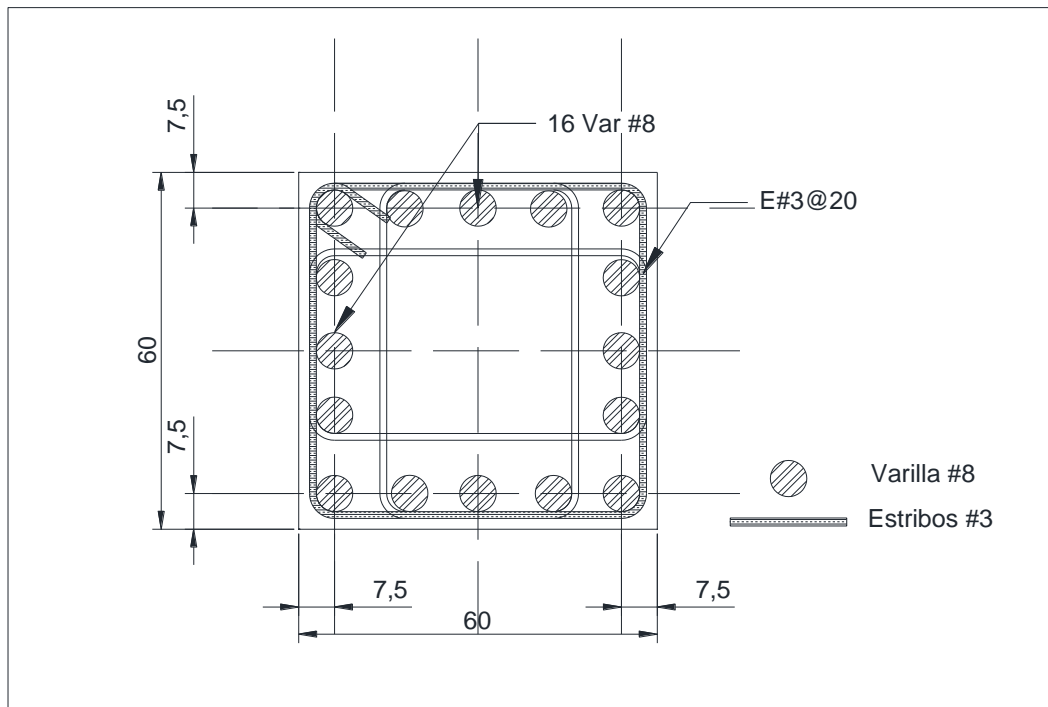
Armado tipo del dado con sección transversal de 60 x 60 cm.
